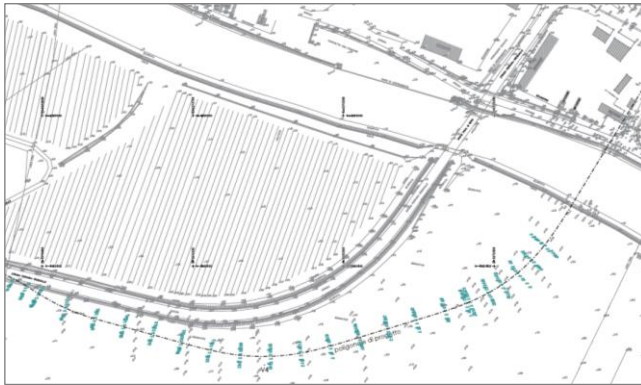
Planimetria dello SdF nel PROGETTO PREGRESSO
